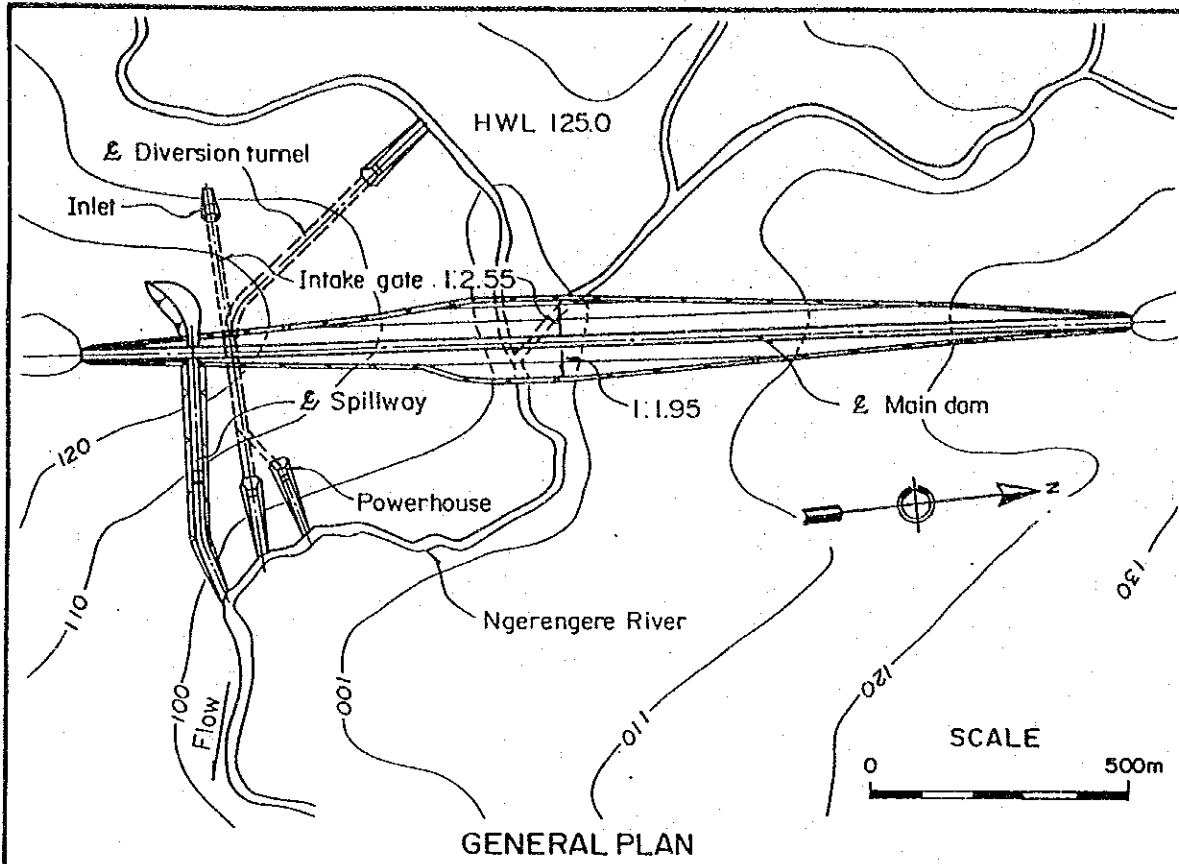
ゲレンゲレ・ダム計画の施設配置図
